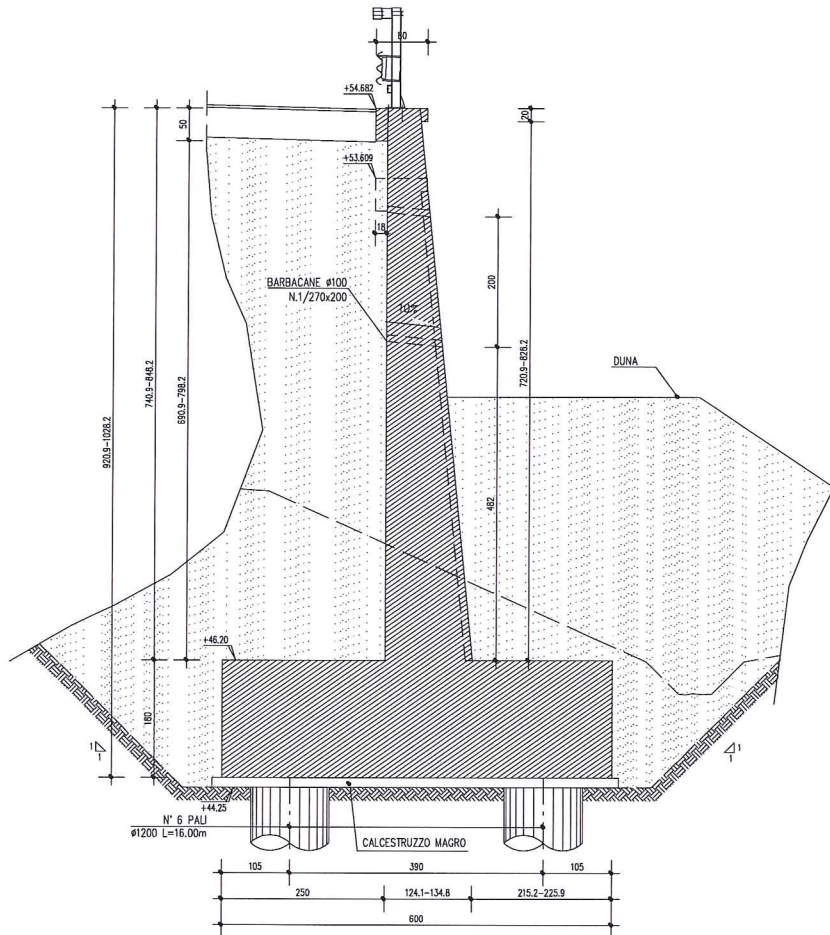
Sezione Tipo - Muro 2 Conci da 10 a 14
